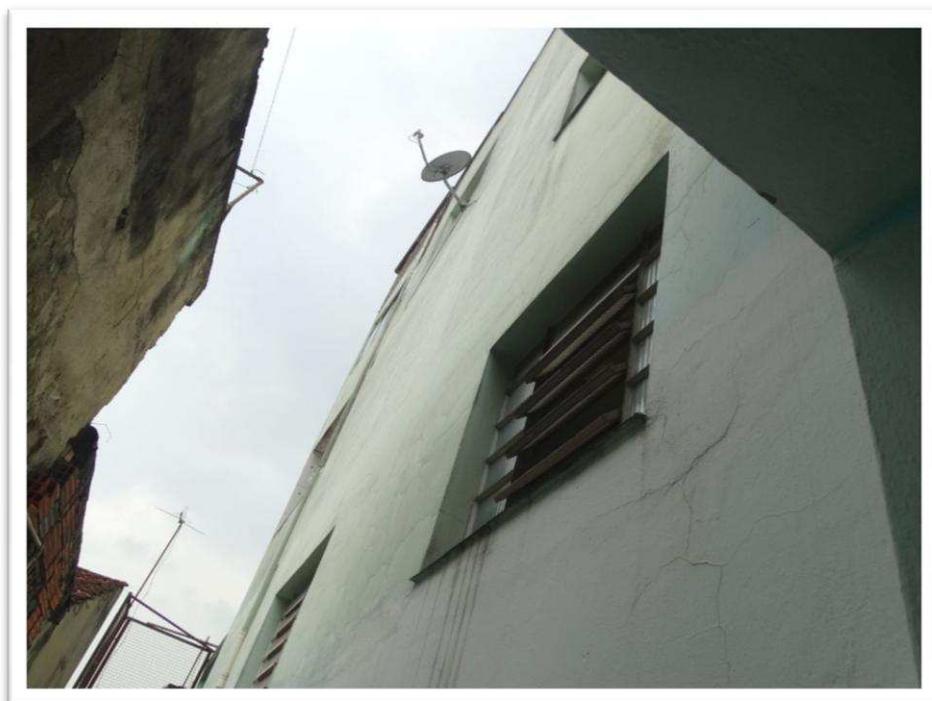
Vista parcial da fachada lateral esquerda do imóvel objeto da vistoria.
